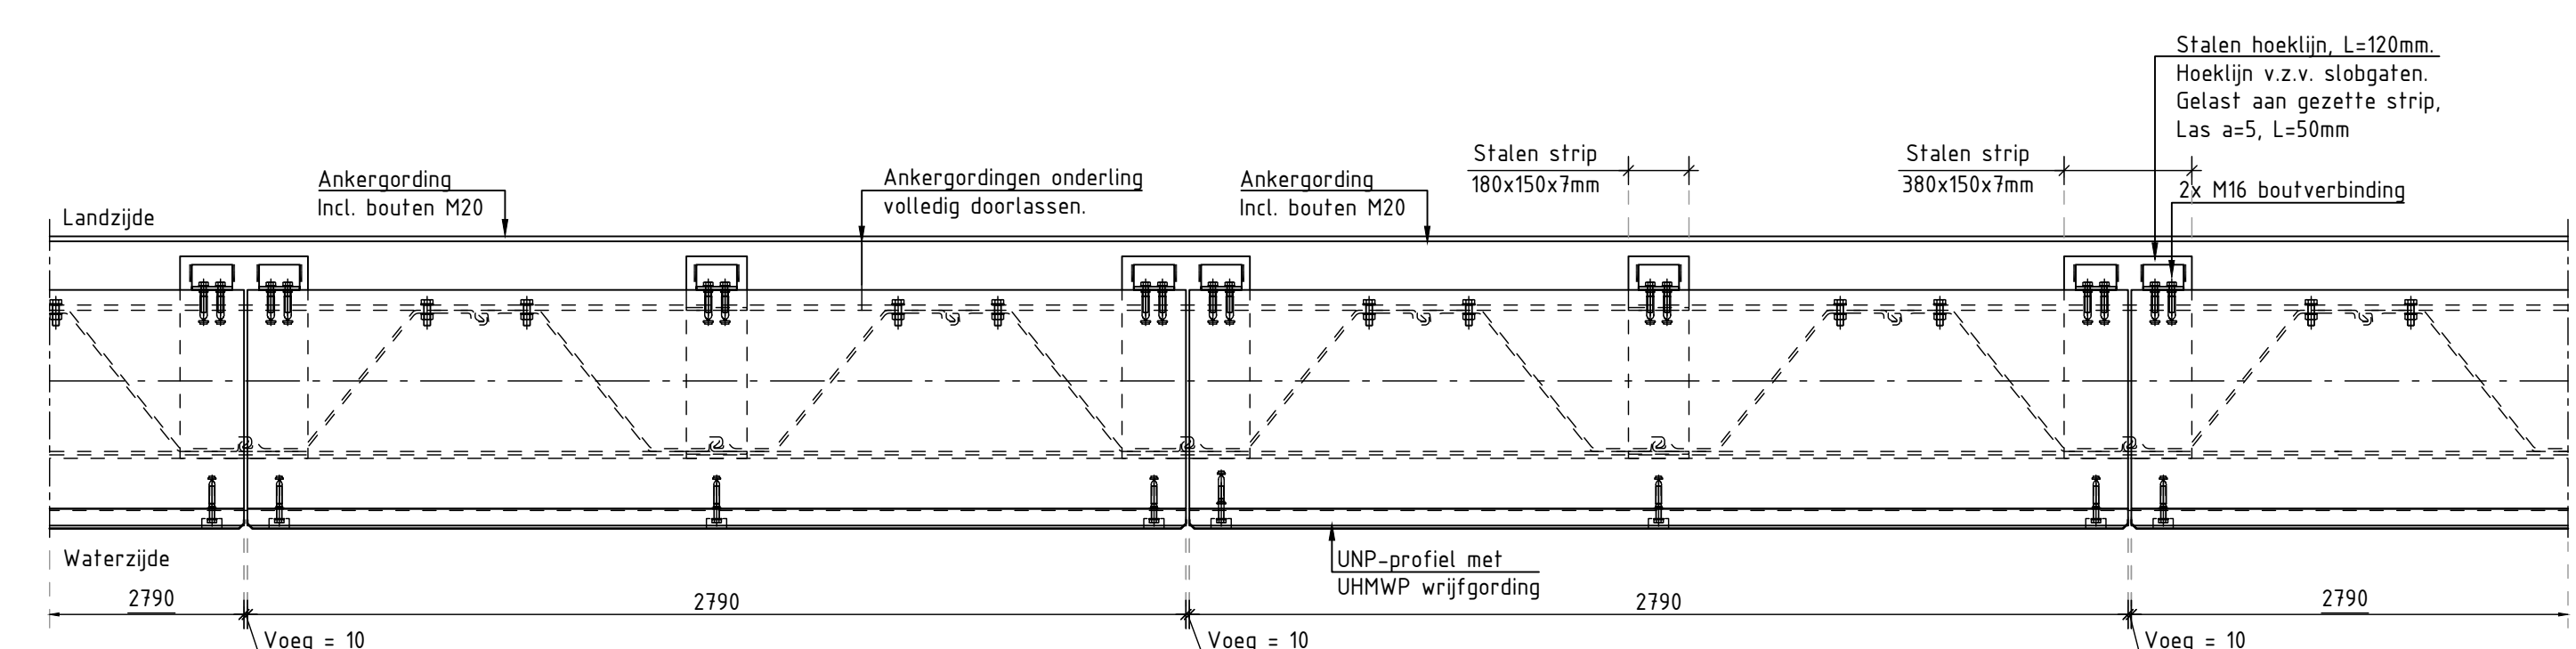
DETAIL STALEN DEKSLOOF T.P.V. GOLFSCHERM
